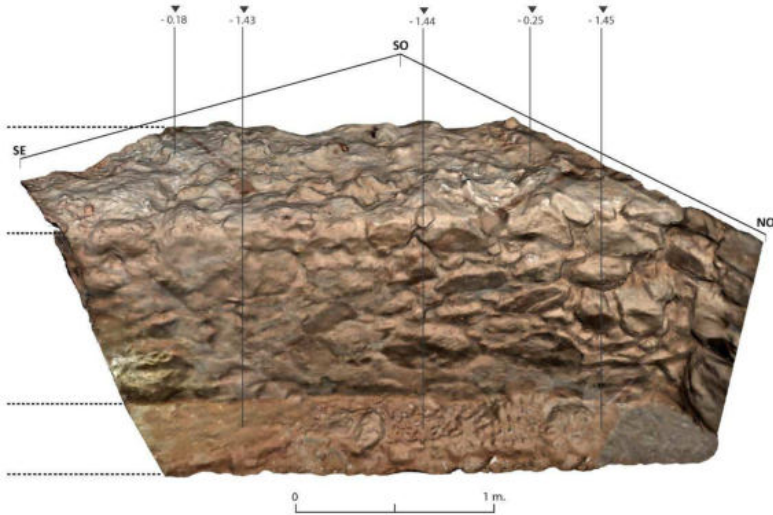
Fotogrametría 3D del tramo excavado de la barbacana en 2018 (Autores).
